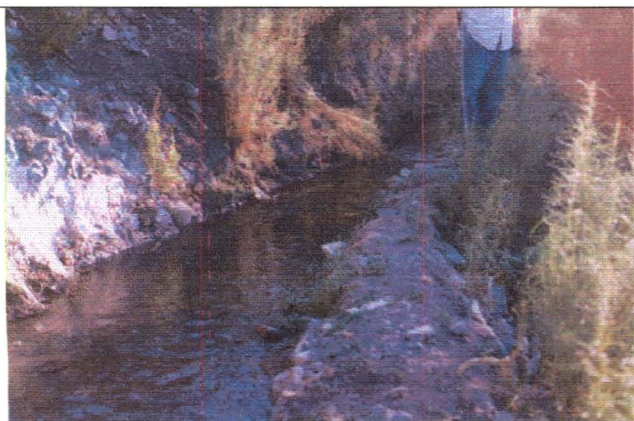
Borde angosto. Borde reconstruido con tierra y piedras.
